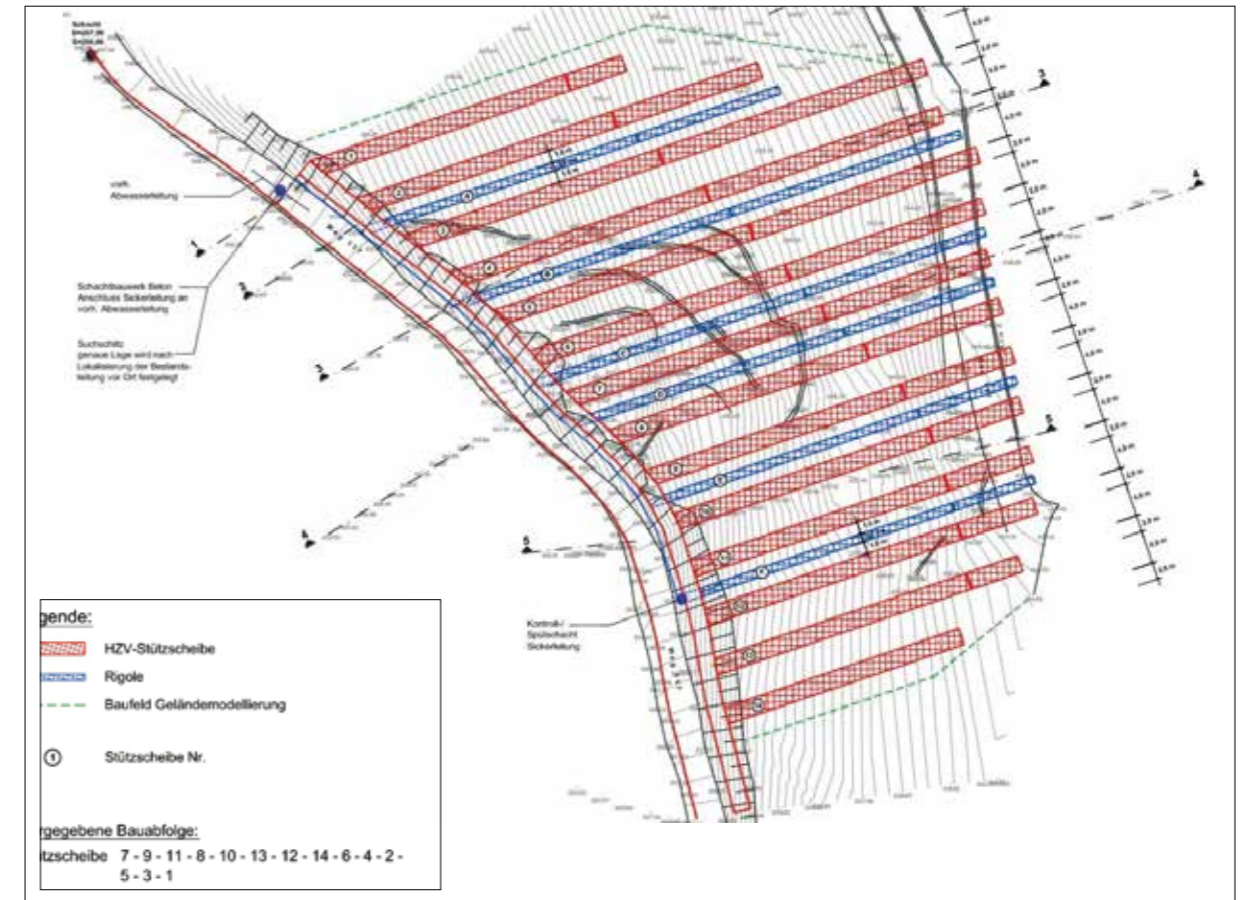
Ausführungsplanung, Lageplan Rigole und Erdbetonstützscheiben
